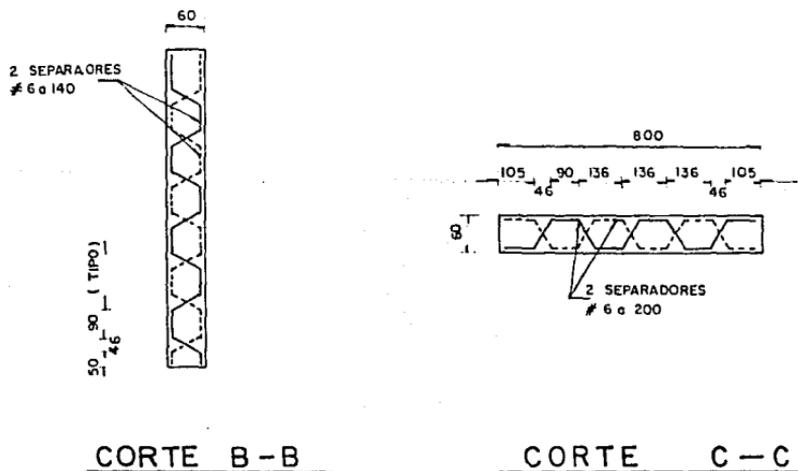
Procedimiento constructivo para unir el muro tablestaca con la losa de fondo y cortes B-B y C-C de la fig. V.3.
